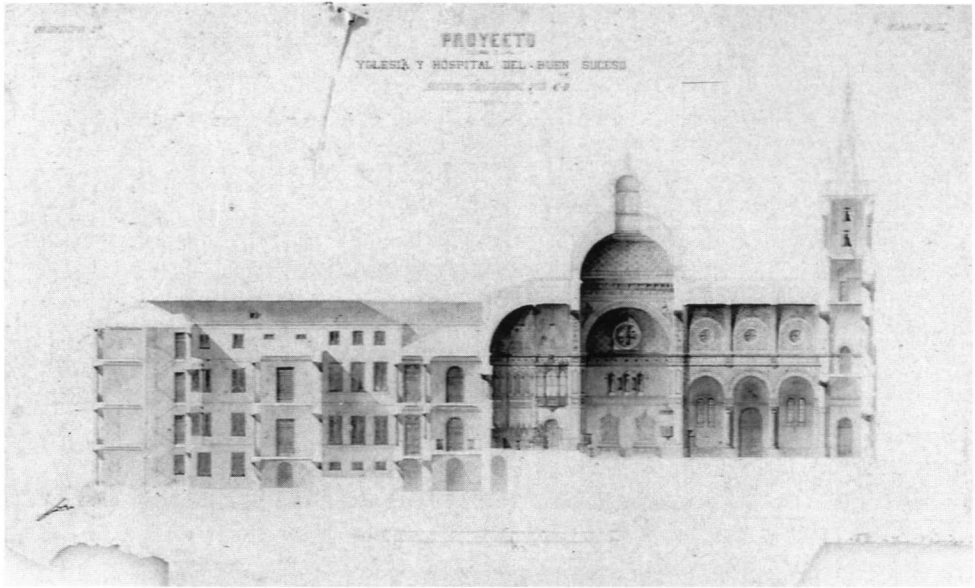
Sección transversal de la iglesia y hospital del Buen Suceso, donde puede apreciarse la decoración arquitectónica interior de la iglesia y campanile con chapitel. Firma: Ortiz de Villajos, AGP, Plano 1613.
